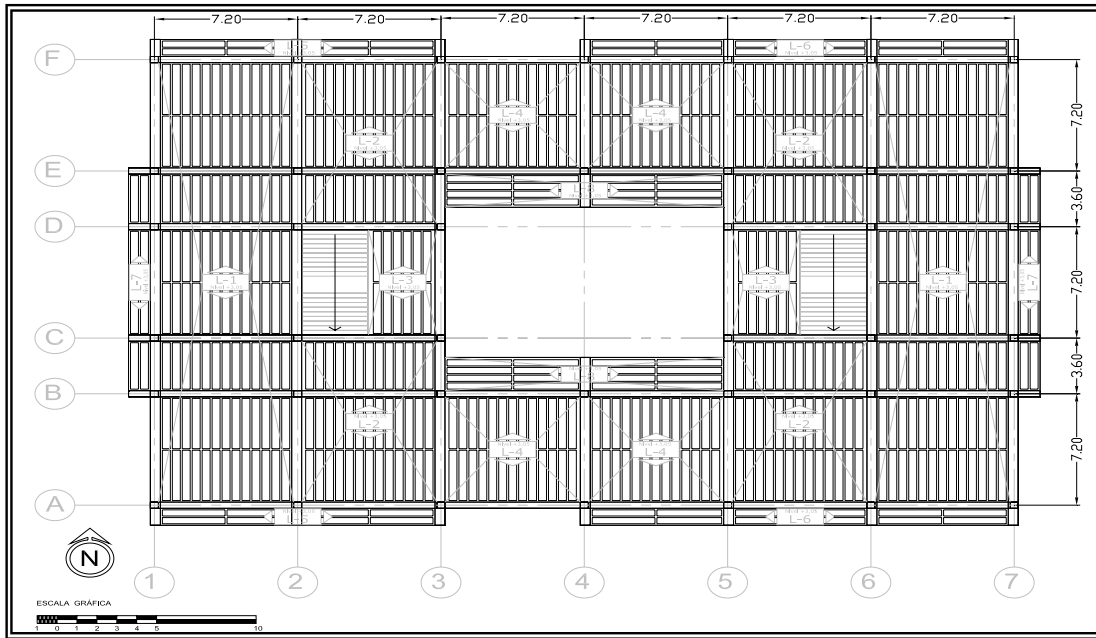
Plano de envigado en planta, niveles 1 y 2, mostrando la dirección de armado de losas
